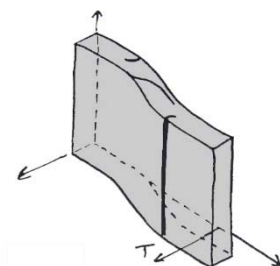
Traslazione trasversale: cedimento terminale lungo
